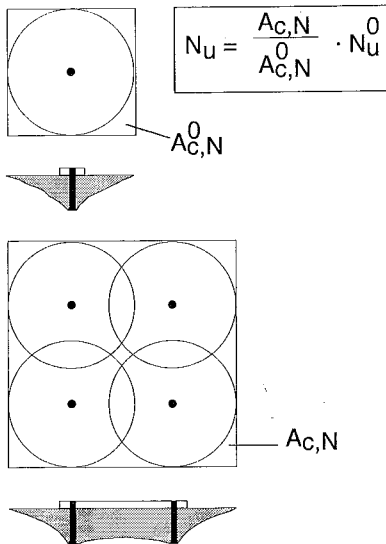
Reduzierung der Betonausbruchlast im gerissenen Beton
